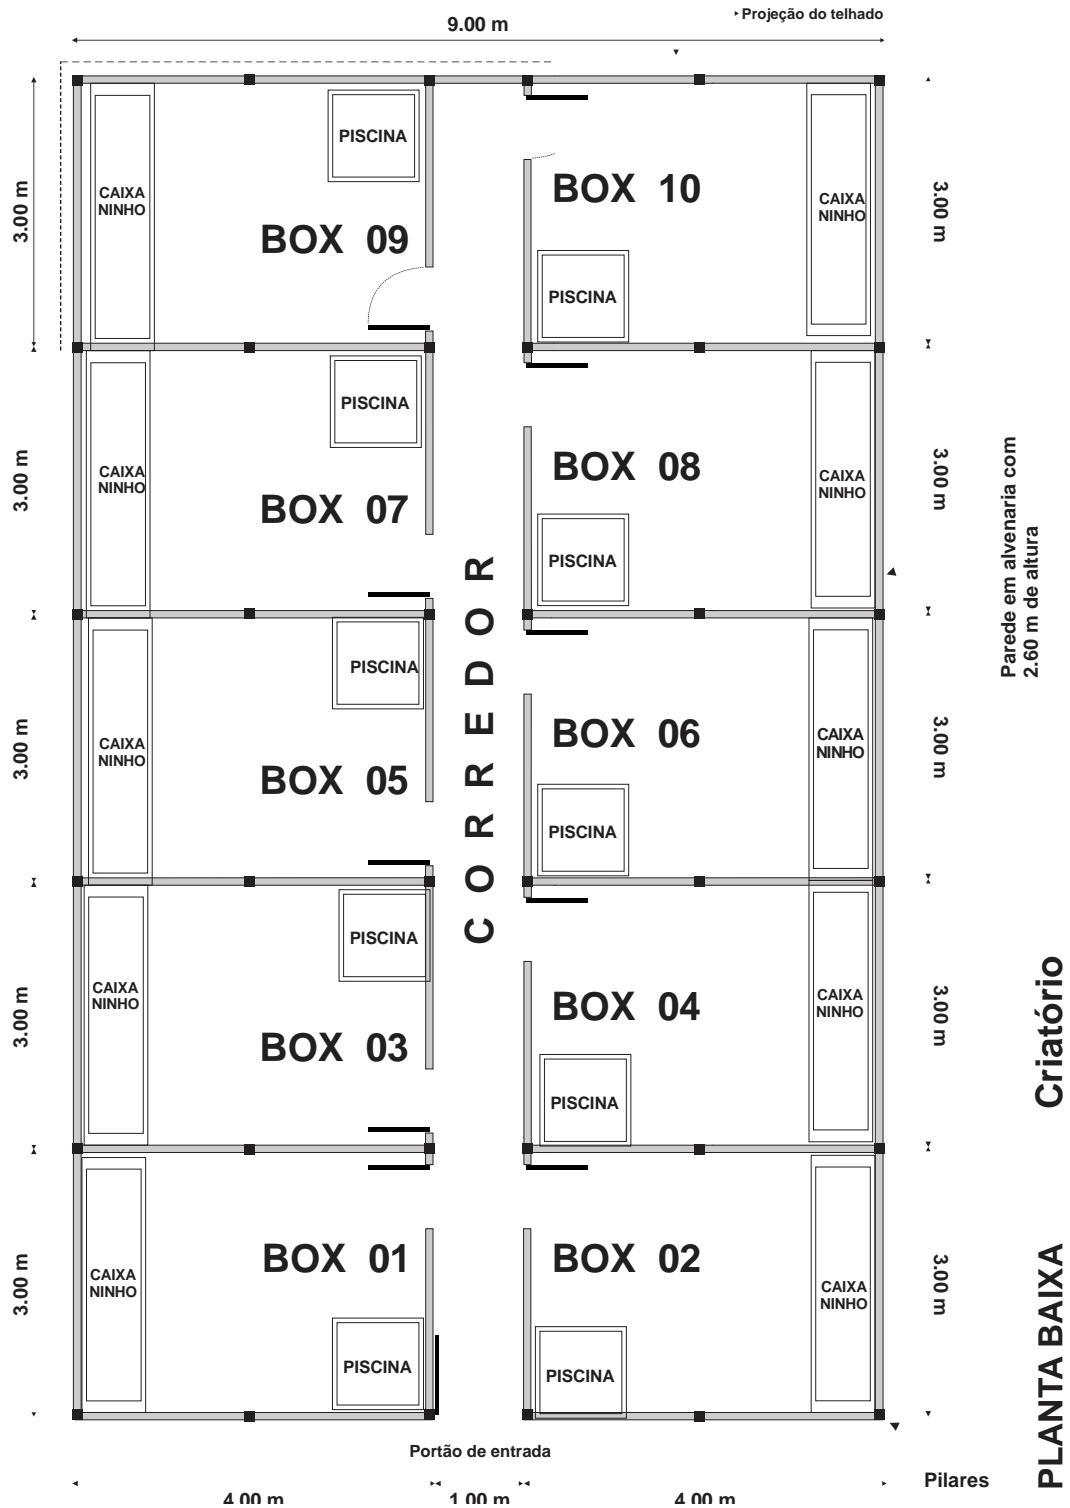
Planta baixa das instalações do setor de reprodução do criadouro comercial.
